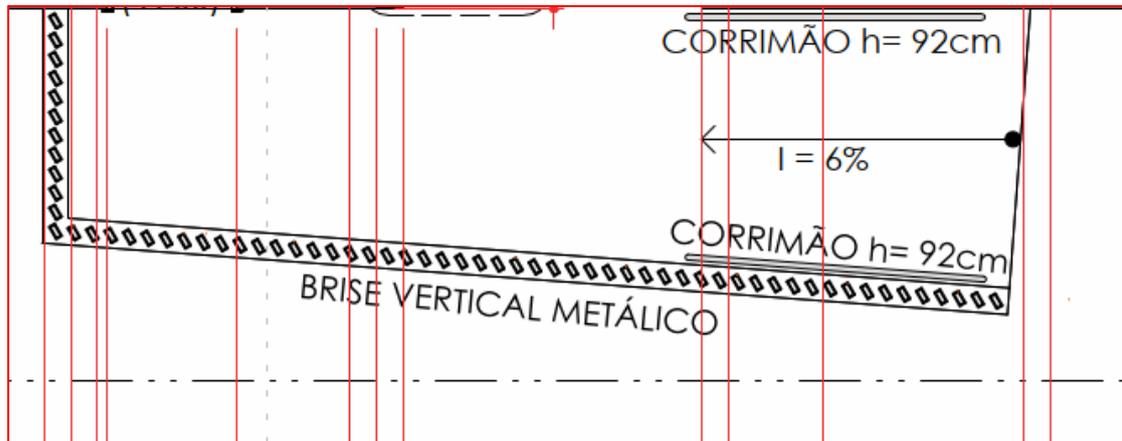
Detalhe em planta de Brise Metálico Vertical – Fonte: CEASA/PR e AUEN
